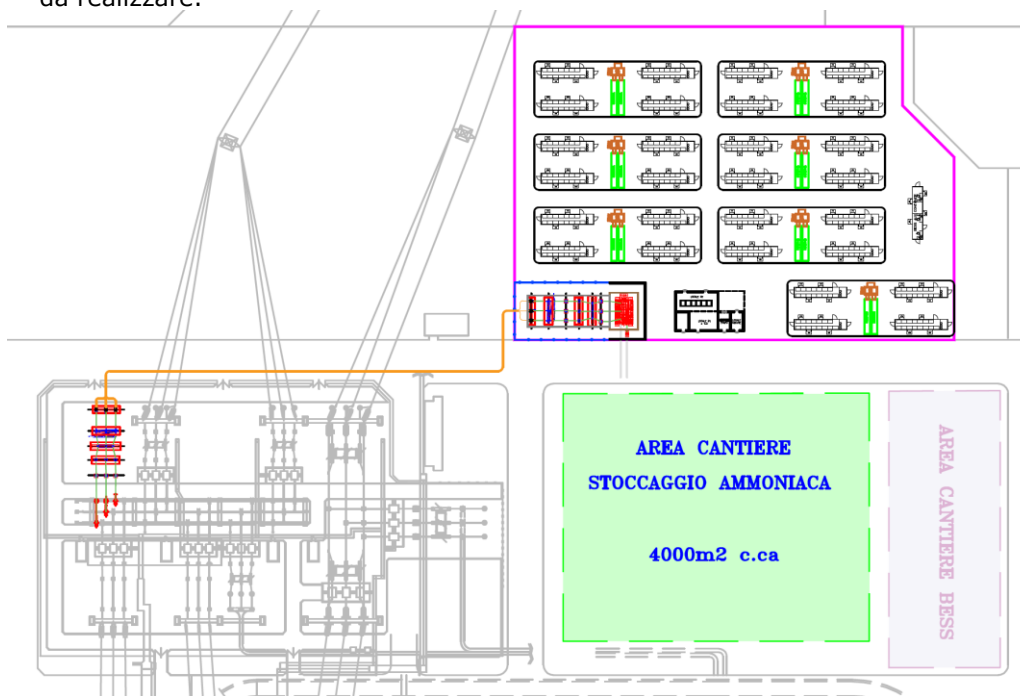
Layout dell'impianto BESS e rappresentazione della connessione
